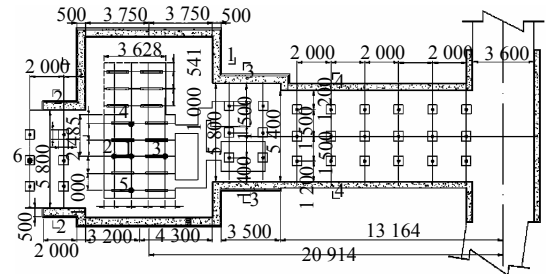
绞车房与绞车基础锚索布置平面图(单位: mm)
